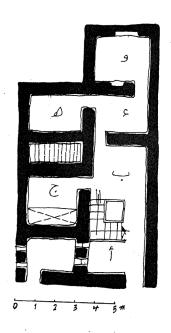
منزل محمد زيهان الدور الأرضى المستوى الثاني – مسقط أفقي
